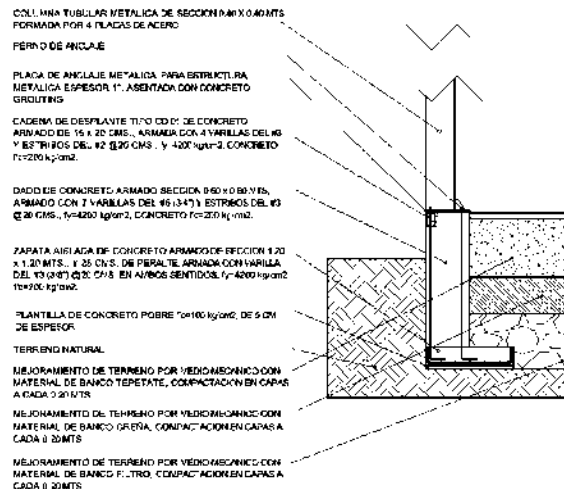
Detalle constructivo realizado por el sustenta. Cimentación.
